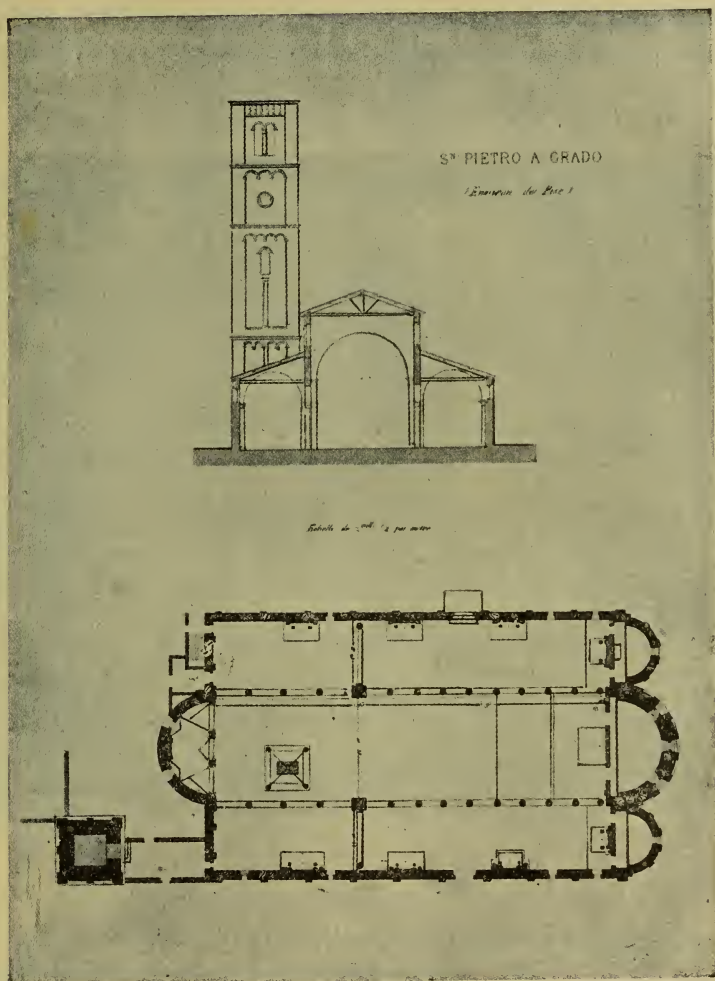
Spaccato e piante della chiesa di San Piero a Grado.
